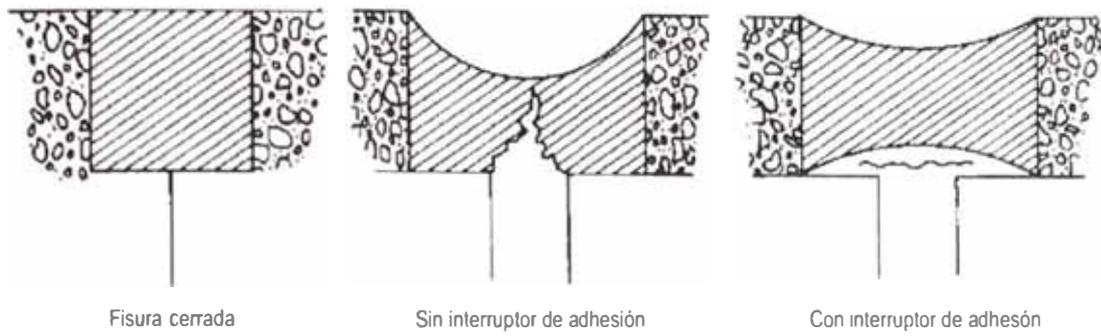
Efecto del interruptor de adhesión en el desempeño del sellador moldeado in-situ
